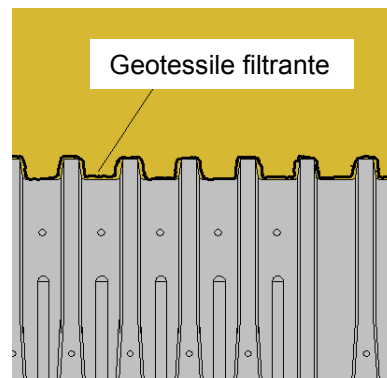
rivestimento con geotessile filtrante sulle file di tunnel
